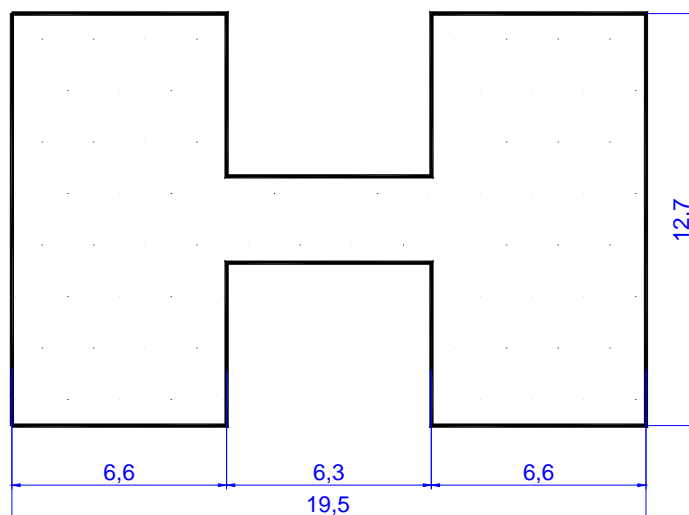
Dimensões em planta dos prédios (m)
